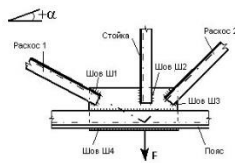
Конструкторский чертеж узла номер 4
